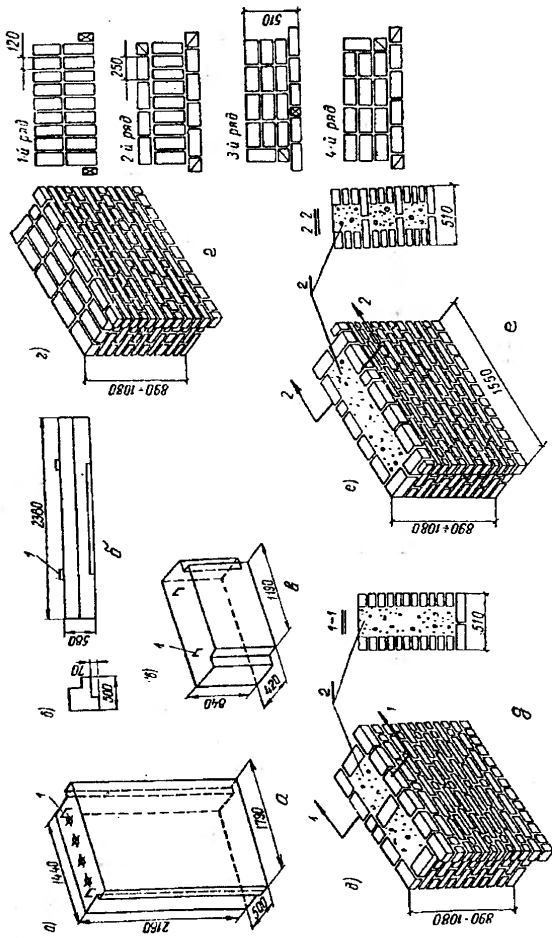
Крупные бетонные (а- простеночный, б- перемычечный, в- подоконный) и кирпичные (г- сплошной; д- колодезный; е- кирпичебетонный) блоки для наружных стен. 1- монтажные петли; 2- эффективный теплоизоляционный материал
